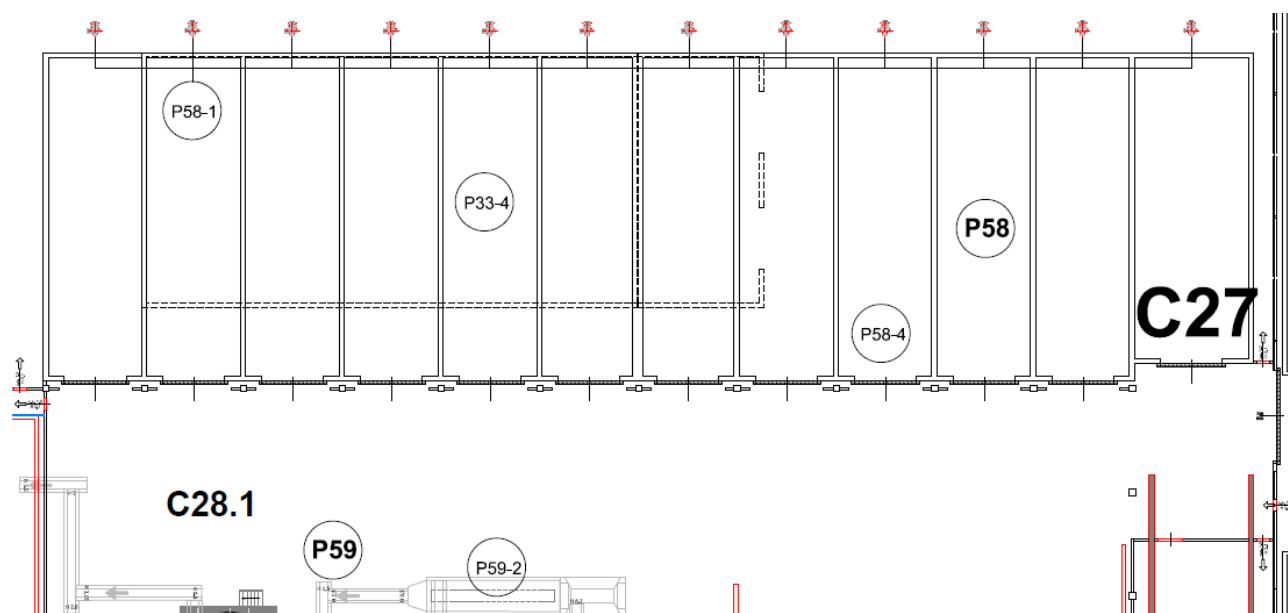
Sezione di stabilizzazione aerobica P58-4
